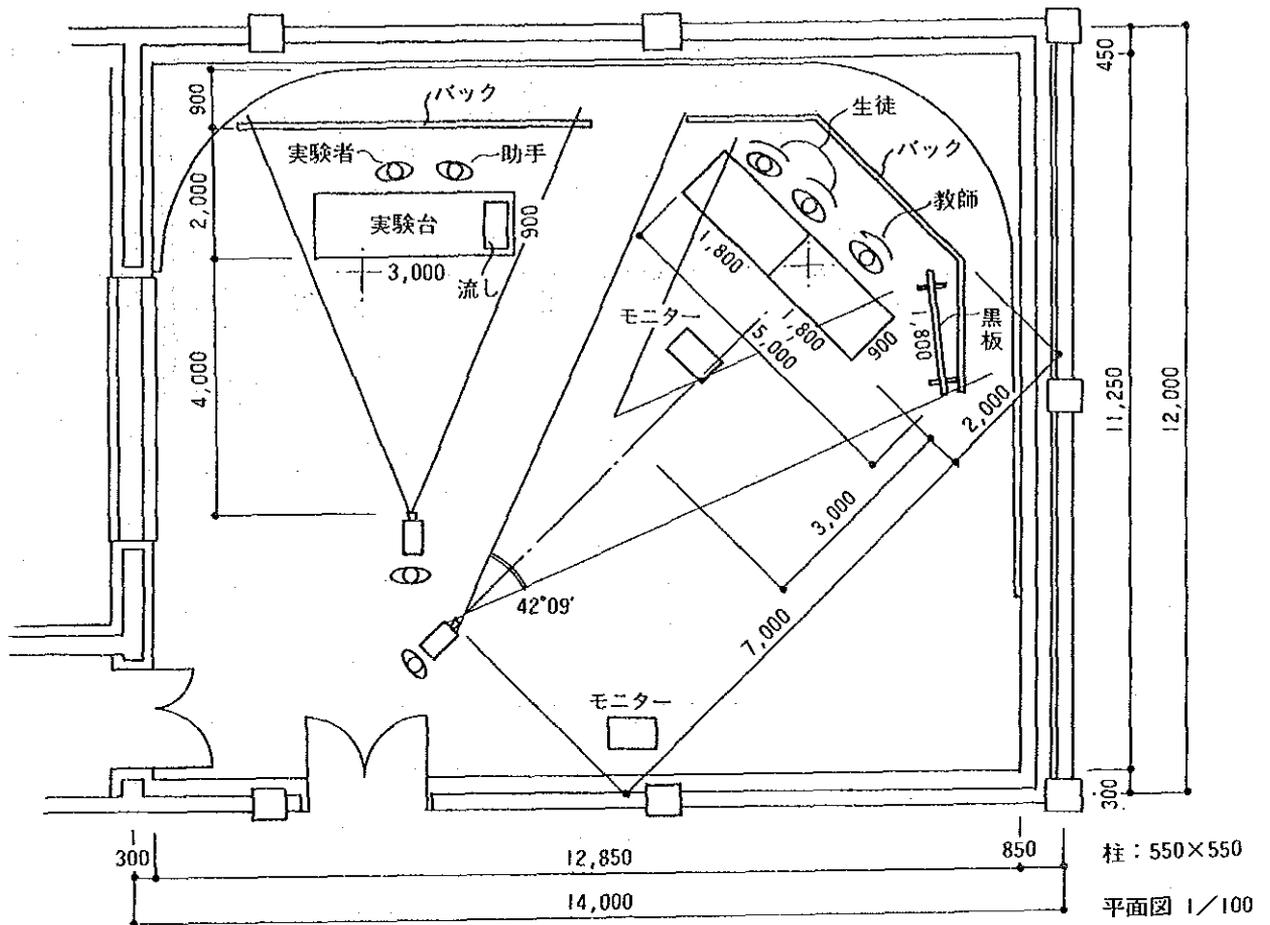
映像教材制作スタジオにおける制作例 (平面図)
